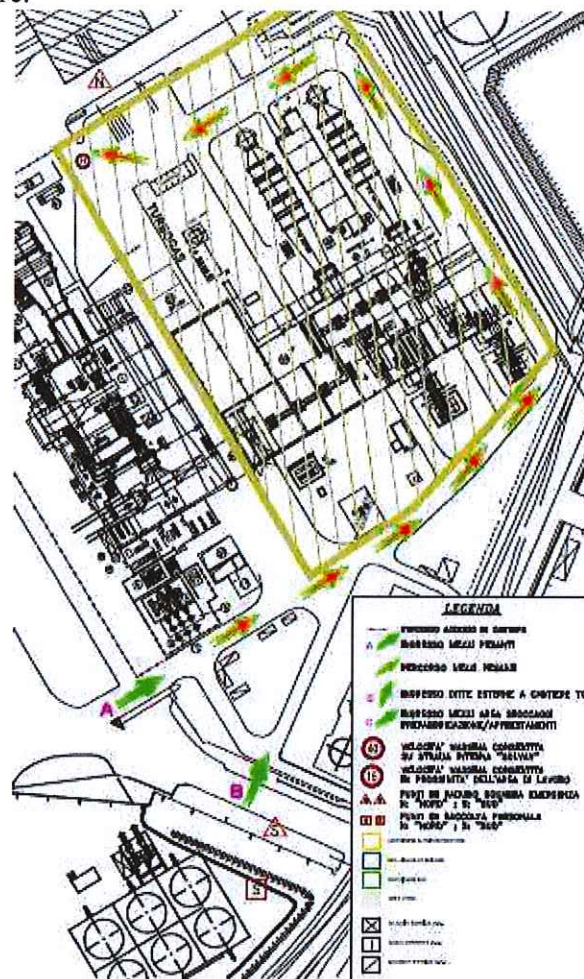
Planimetria aree di cantiere ed area esterna (da PSC)
